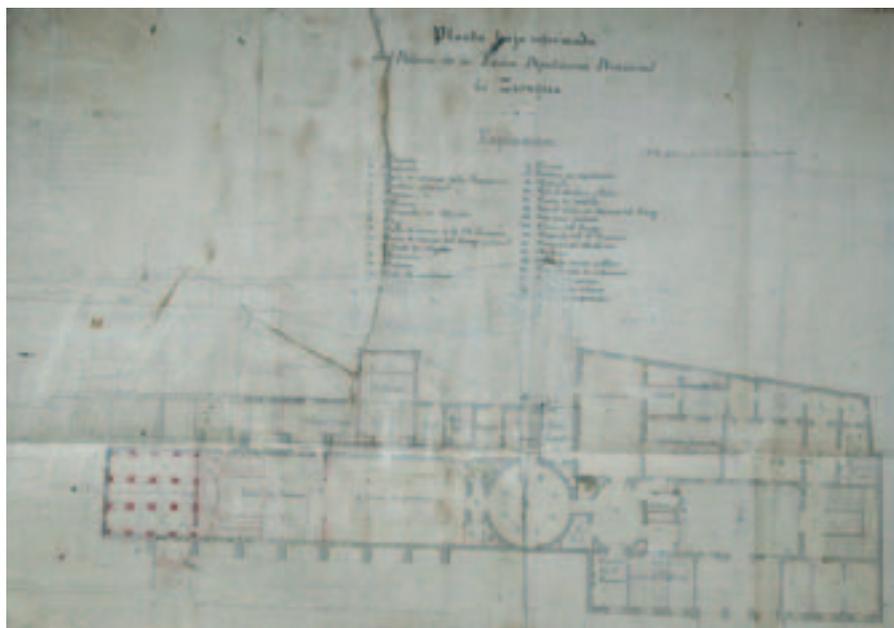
Planta baja del proyecto de Pedro Martínez Sangrós de 1857 (A.D.P.Z.).
